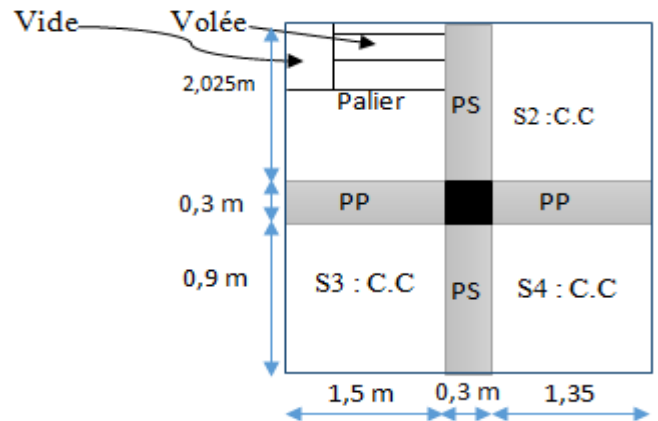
Surface afférente du niveau 7 → entre sol 1
